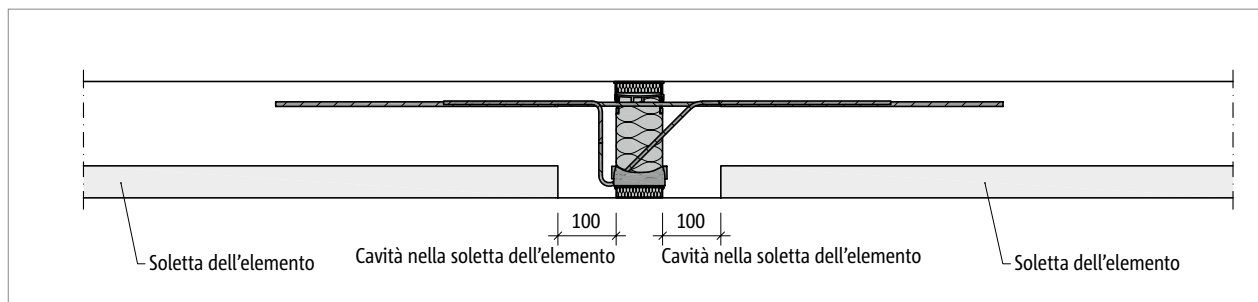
Schöck Isokorb® T tipo KL: montaggio con lastre prefabbricate, giunto a compressione sul lato del solaio e del balcone
